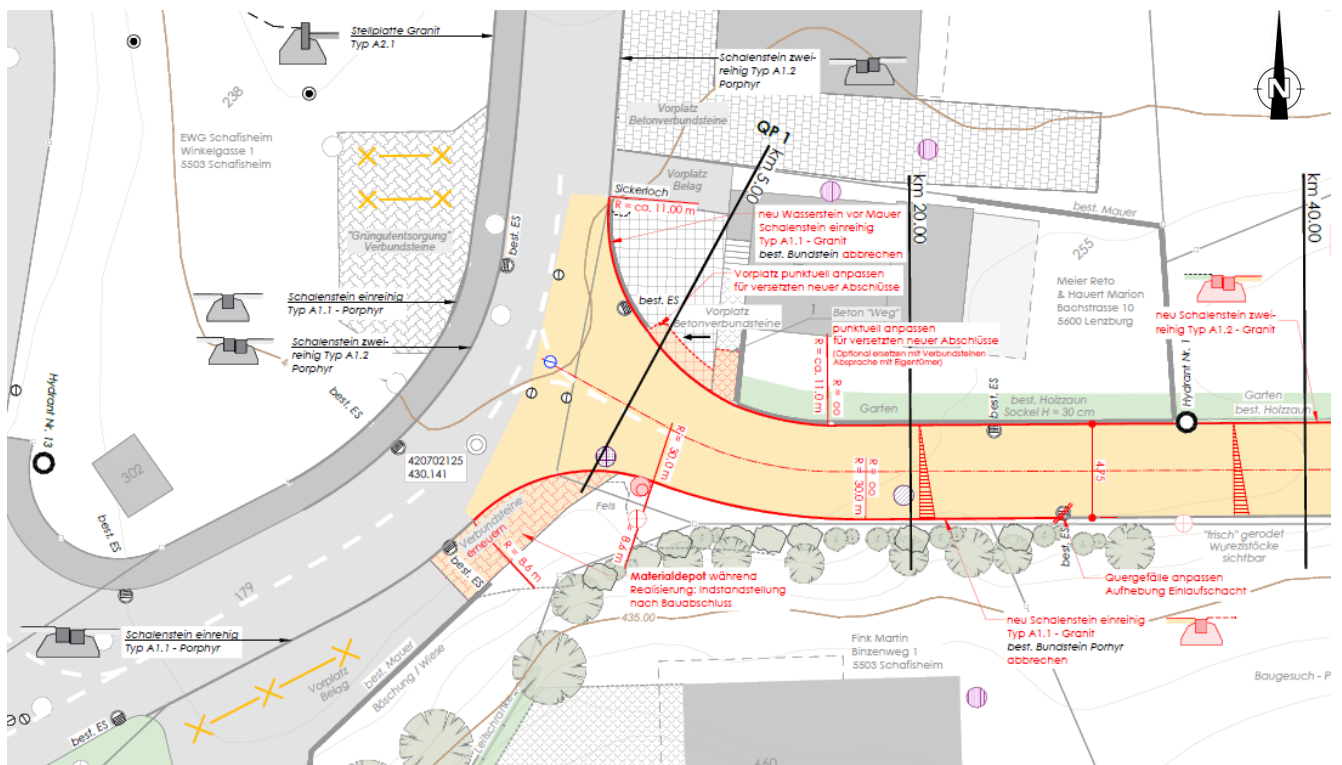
Planausschnitt Situation Knoten Talhausstrasse
